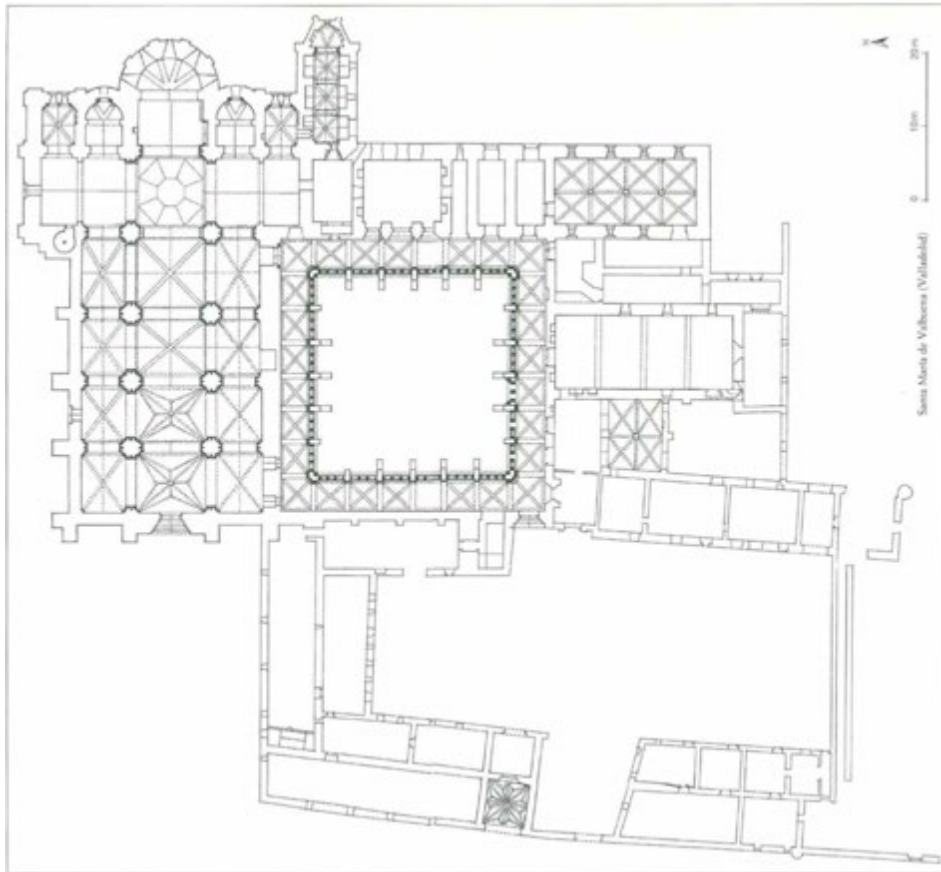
Valbuena, Santa María, Grundriss Kirche und Klausur.
